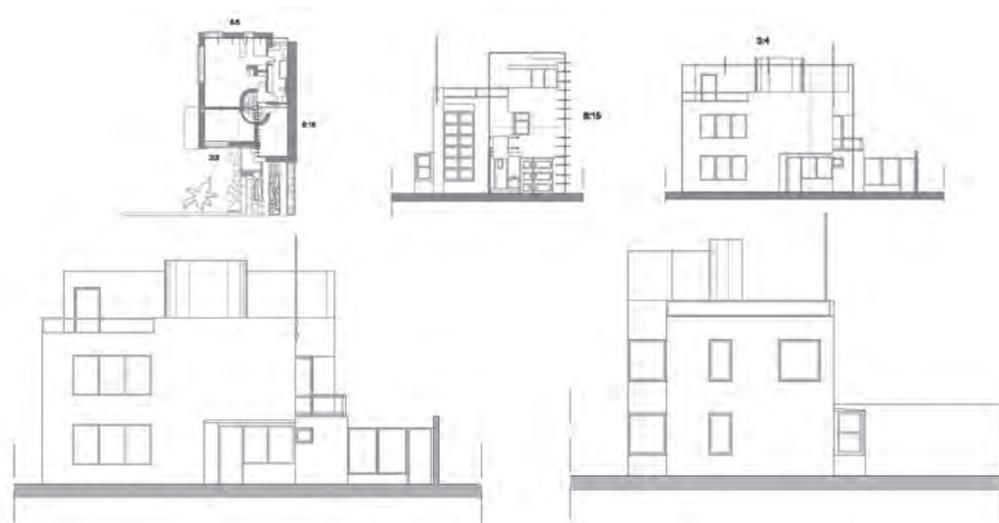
Ridisegno dei prospetti e rapporti armonici.
